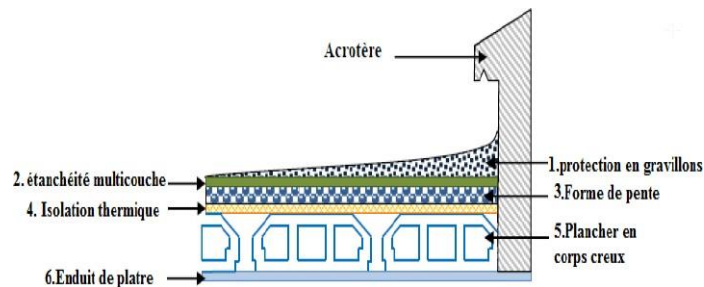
Plancher terrasse inaccessible à corps creux.
